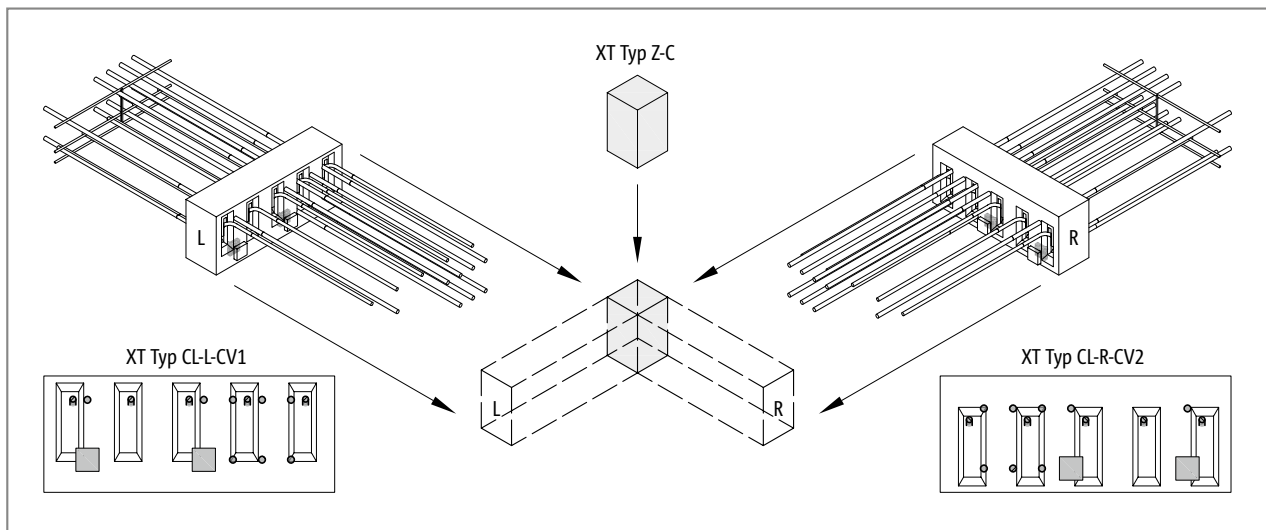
Schöck Isokorb® XT Typ CL-L-CV1, XT Typ CL-R-CV2: Anordnung an der Ecke mit Eck-Dämmkörper
